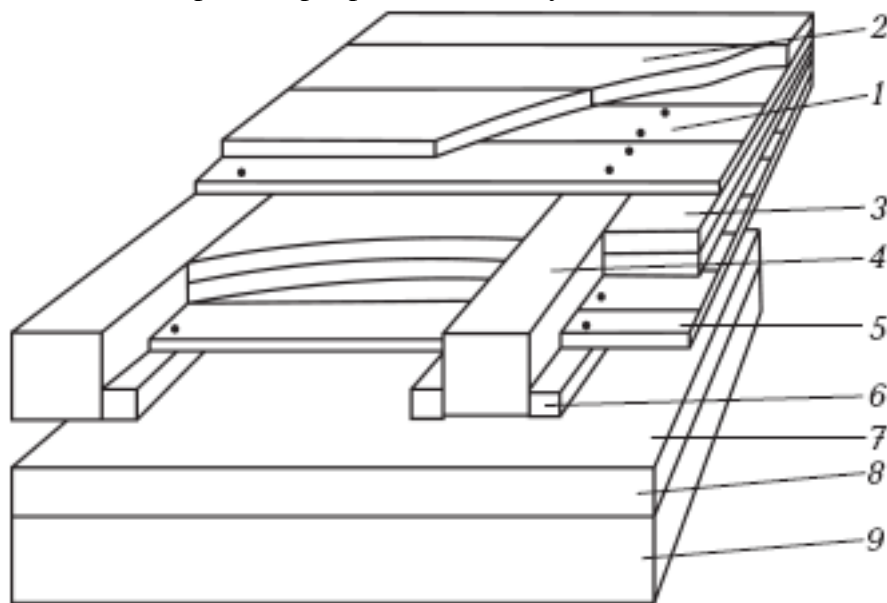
Схема утепления перекрытий первого этажа по деревянным балкам: 1 – черновой пол; 2 – чистовой пол; 3 – утеплитель; 4 – лаги пола; 5 – накат из досок; 6 – черепной брусок; 7 – воздушный зазор; 8 – песчаная засыпка; 9 – уплотненный щебнем грунт
